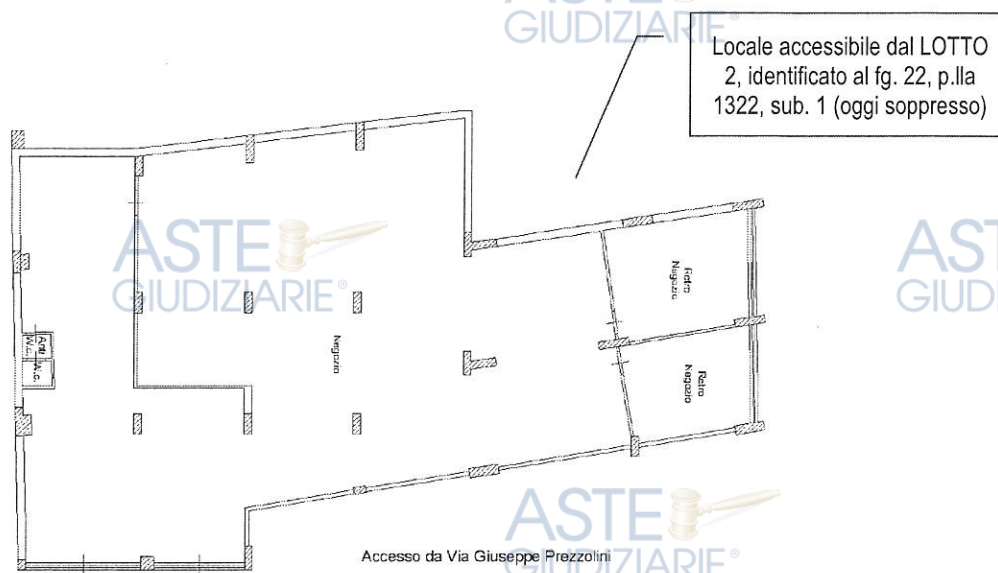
Planimetria catastale attuale - Prot. n. T381408 del 25/01/2024 (vedi allegato A)
